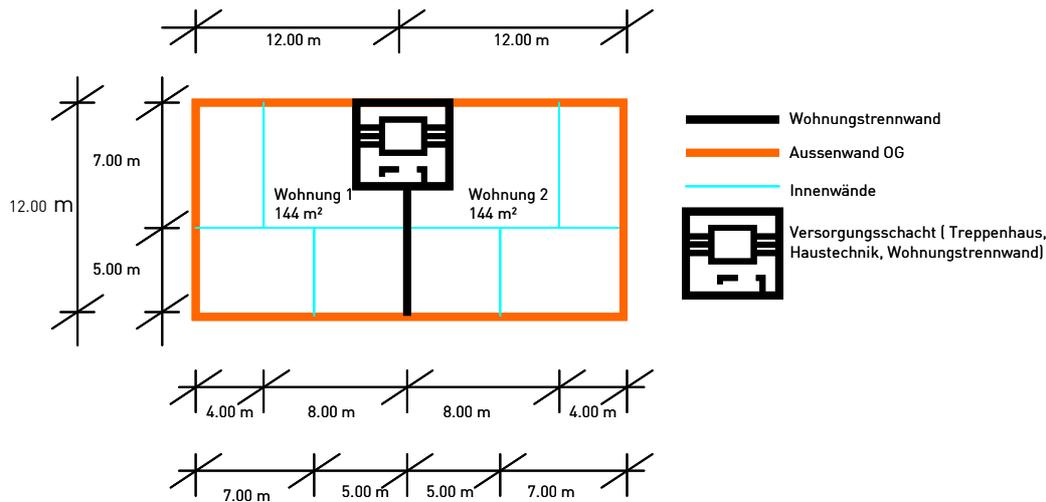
Standardgrundriss (Anmerkung: keine Innenwände im UG).
